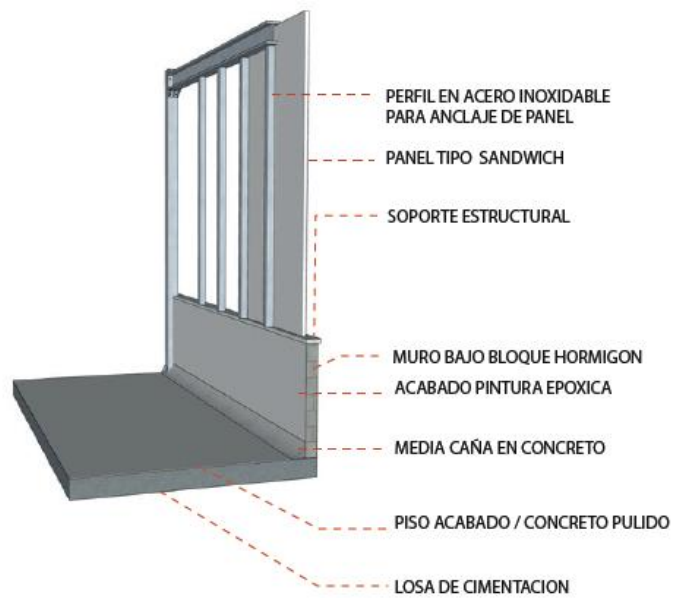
Detalle fachada área de producción, panel tipo sándwich.
